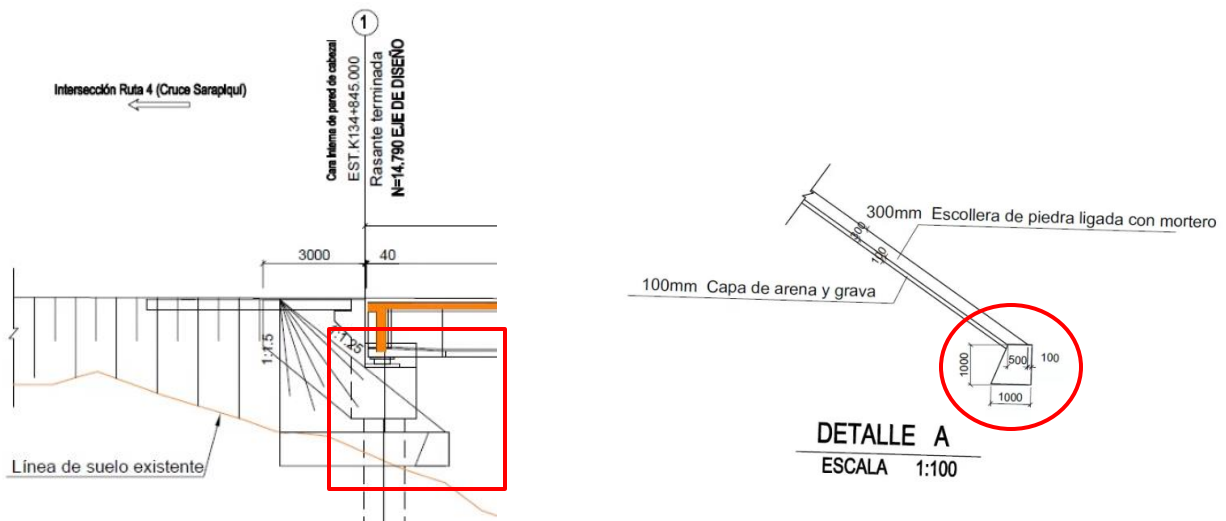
Detalle de las escolleras ligadas con mortero del puente nuevo sobre el río Rojo.
